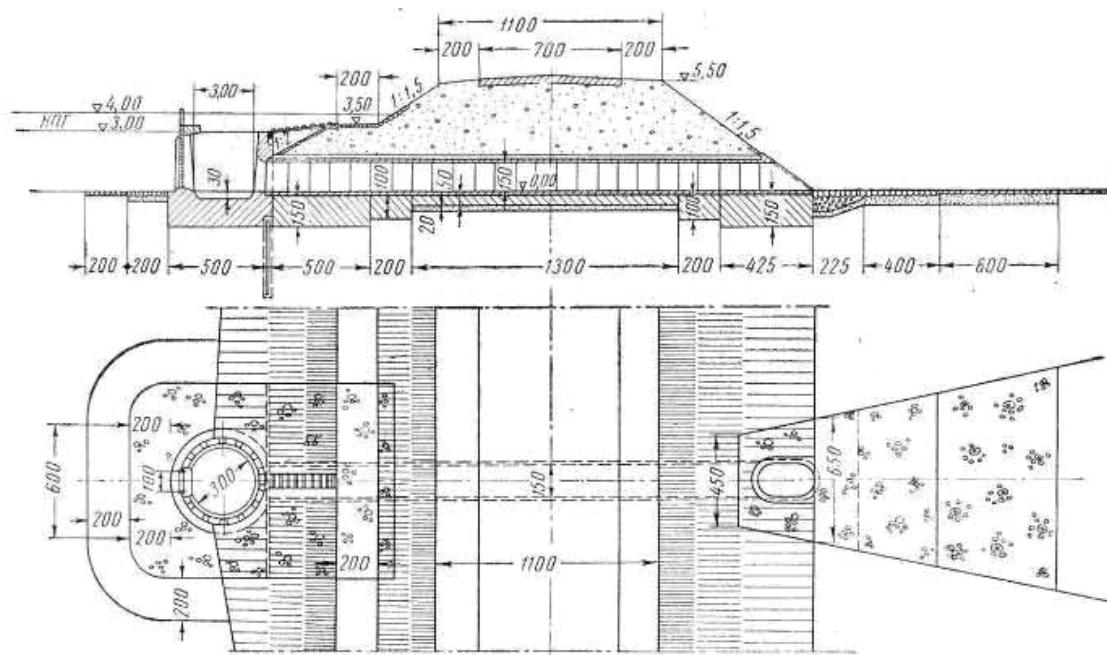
Продольный разрез и план трубчатого водосброса с шахтно-башенным входным оголовком
